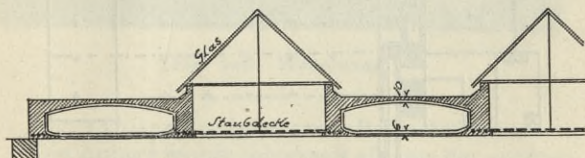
Isolierdecken aus Eisenbeton und Glas.
